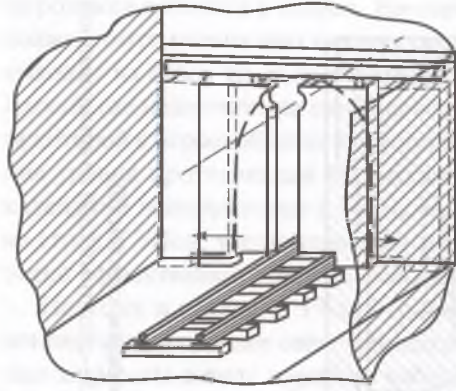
Теплоизоляционные ворота на порталах Северо-Муйского тоннеля
